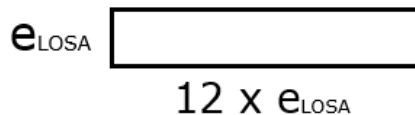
Sección de viga como reemplazo de losa en zonas de acople.
